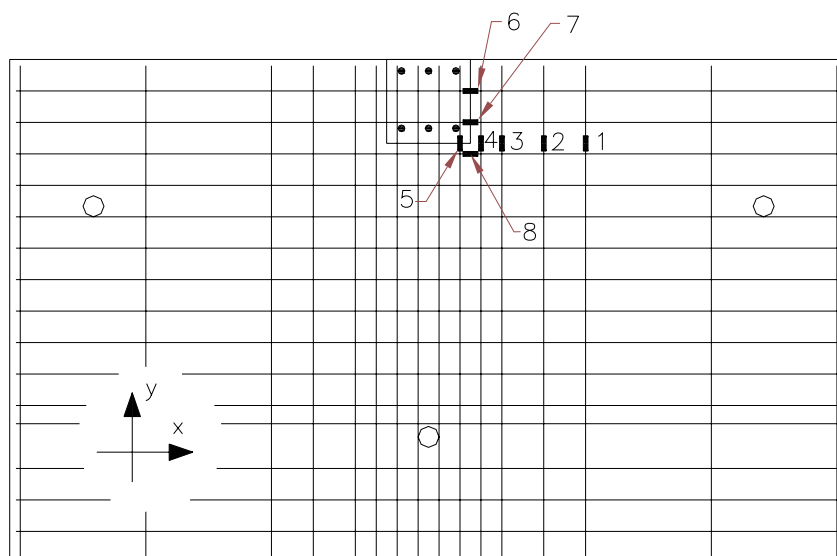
Posicionamento em planta dos extensômetros na armadura passiva
